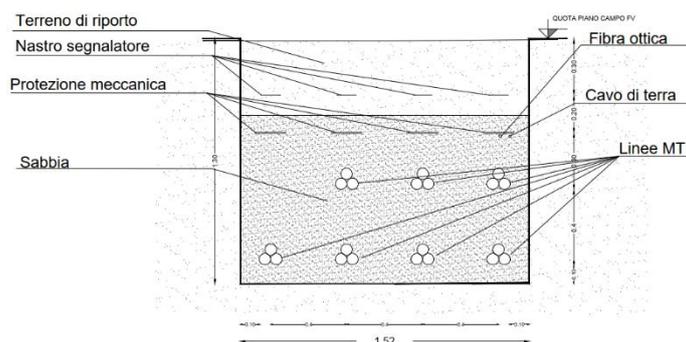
Sezione cavidotto MT interrato a sestupla terna di cavi (Sez. F-F) - estratto tav. GRE.EEC.D.25.IT.P.15533.00.047
